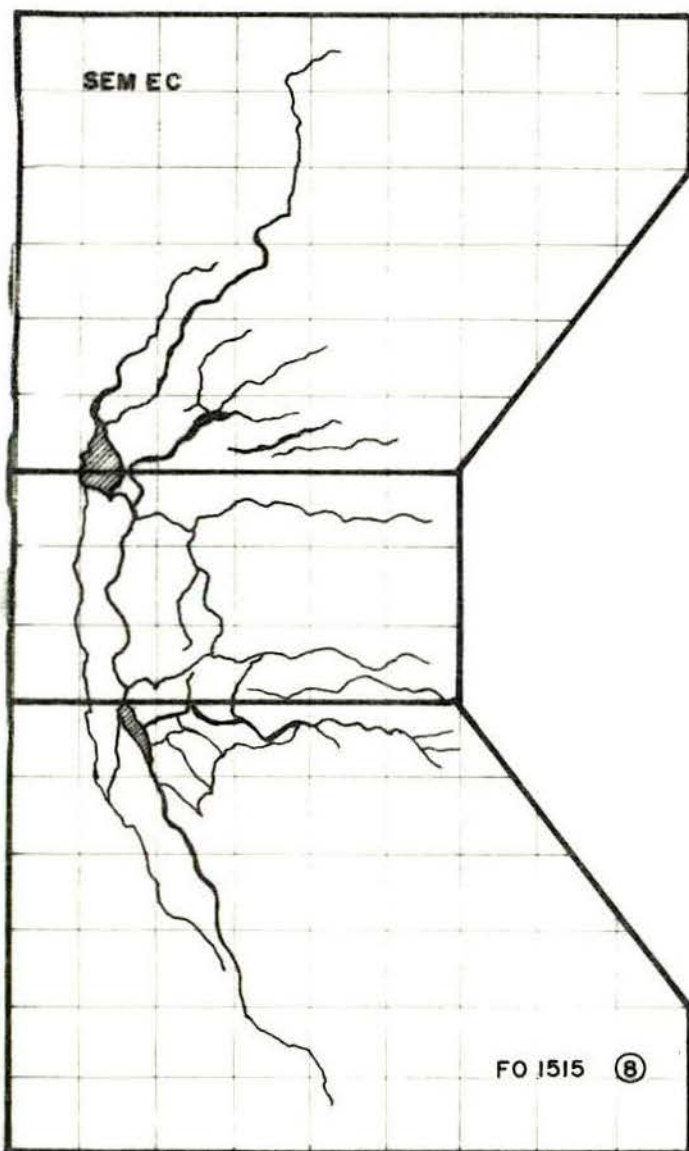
Fissuração dos CP FO1515
